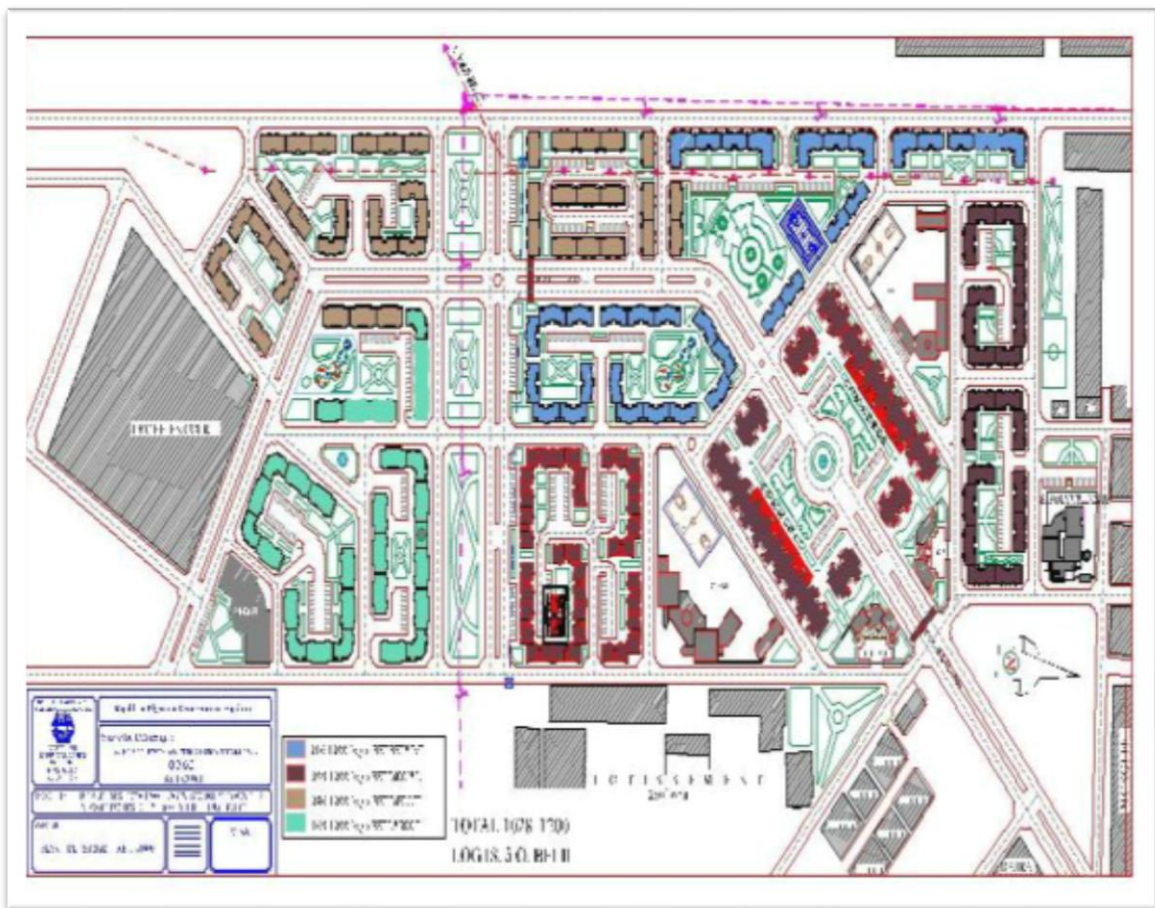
Plan de masse du projet 1200 logements, ville nouvelle de Bellil
